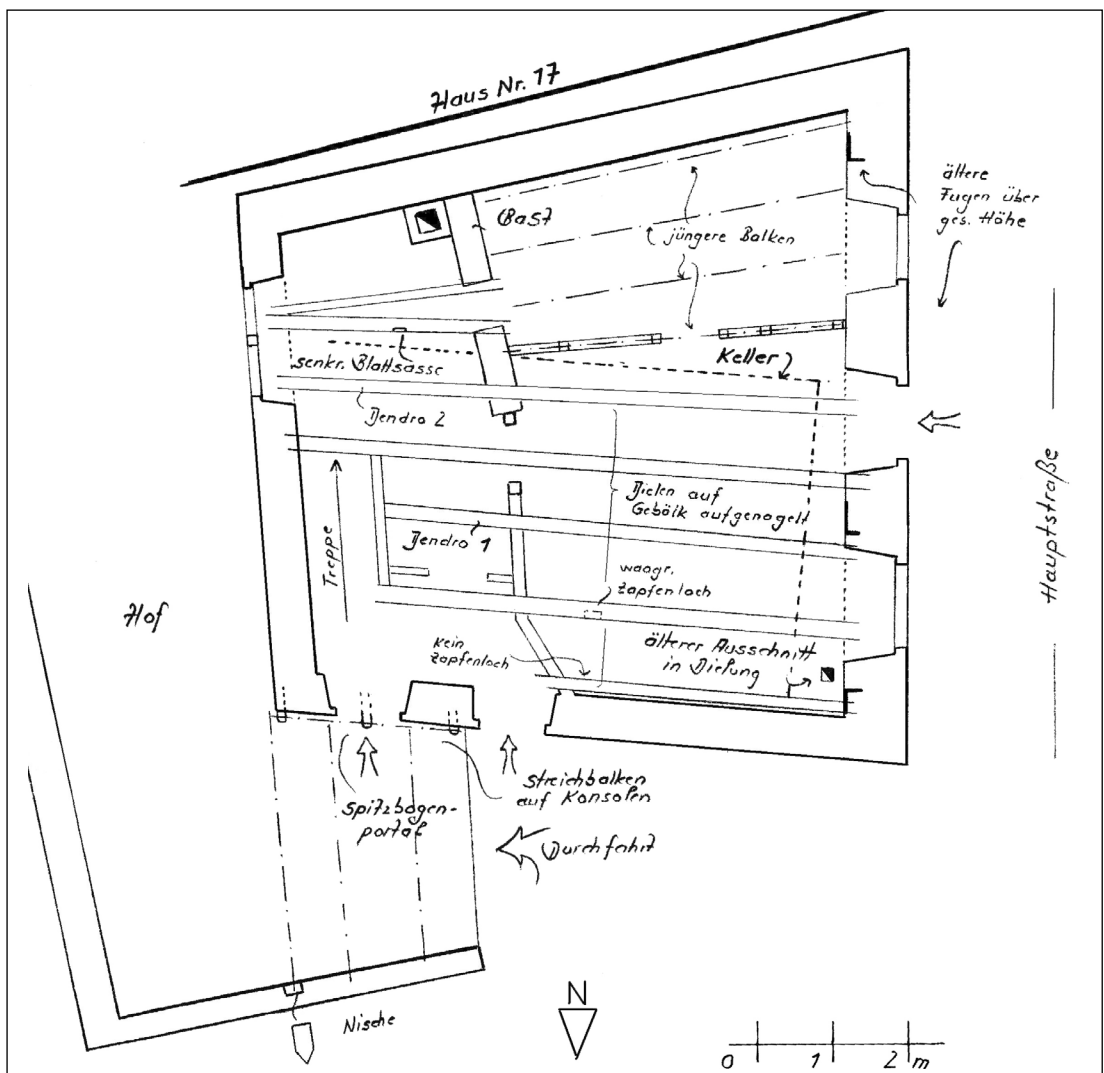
Hauptstraße 15, Grundriss Erdgeschoss.
